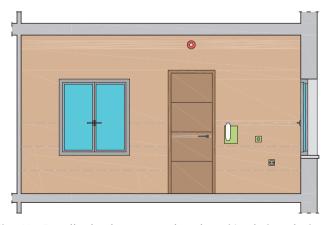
Detalle de alturas para la colocación de instalaciones.
